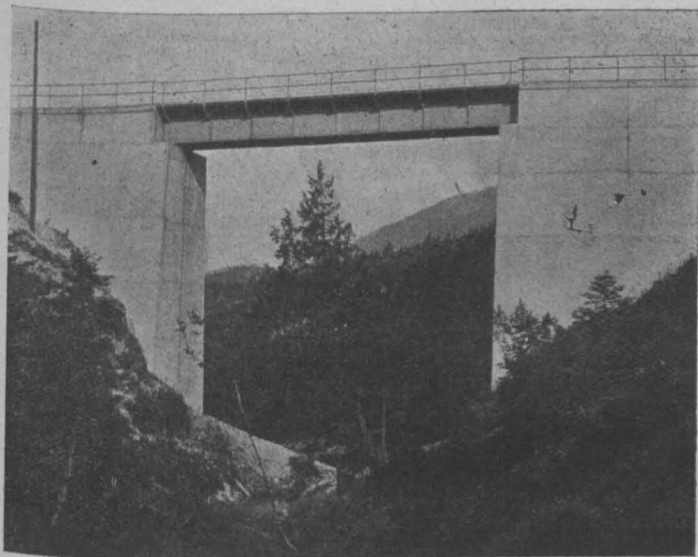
Brücke mit Stampfbetonwiderlagern.
